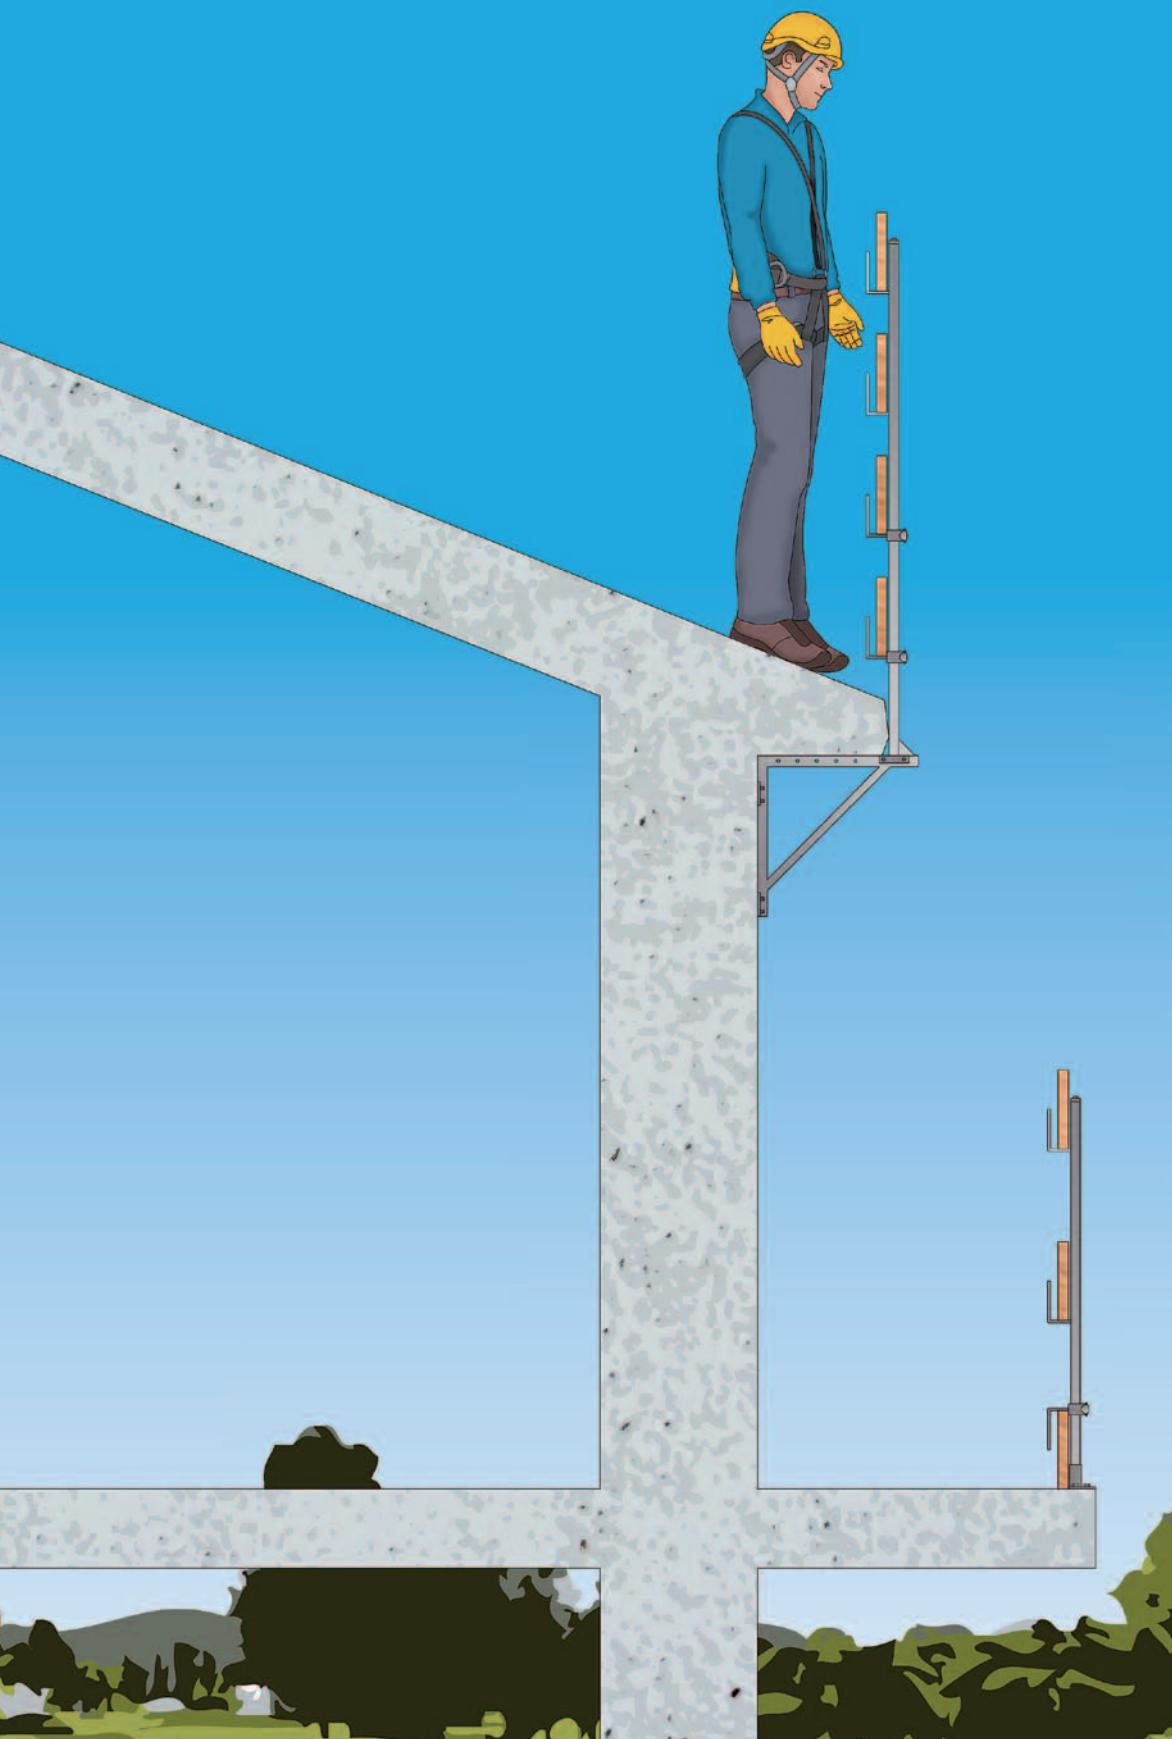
Parapetto provvisorio montato su soletta di calcestruzzo armato
